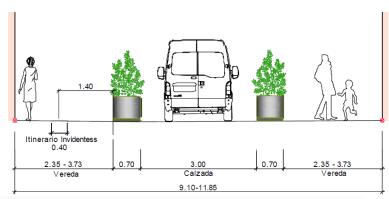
Detalle corte propuesta peatonalización Jr. Pizarro e Independencia
